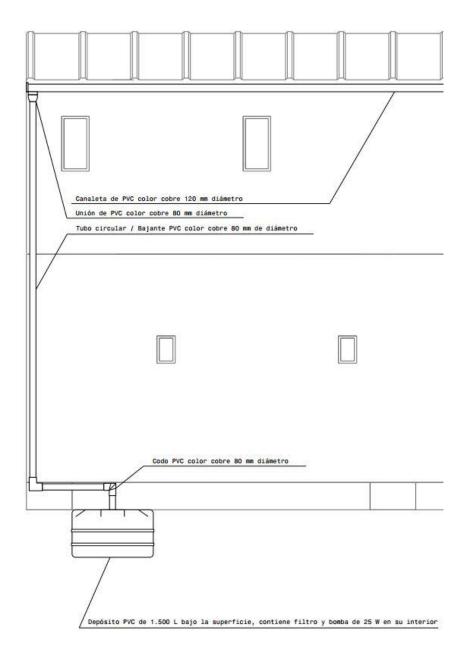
plano sistema de aprovechamiento pluvial Néo Oikos Fuente: elaboración propia
